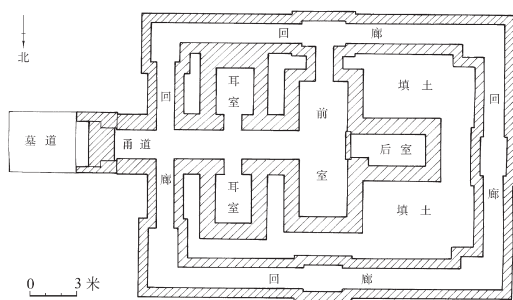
河南省淮阳北关 1 号墓平面图 (1/500)
